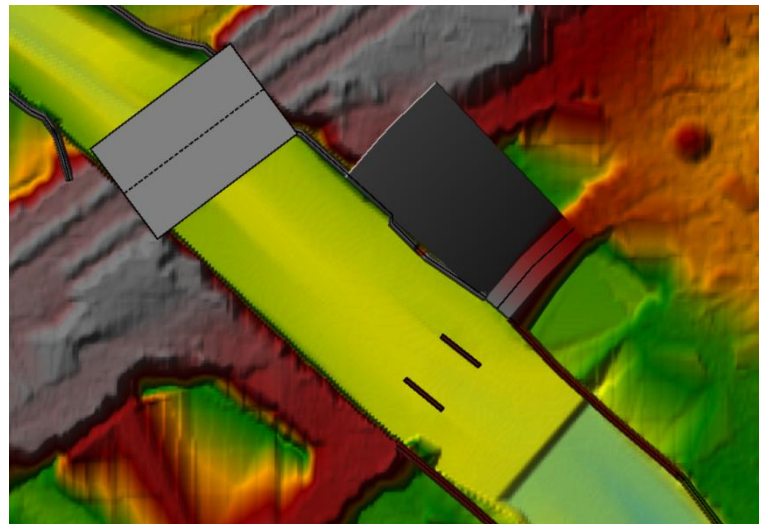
Schematizzazione in pianta dell'attraversamento ferroviario esistente e delle pile del ponte stradale a valle.
